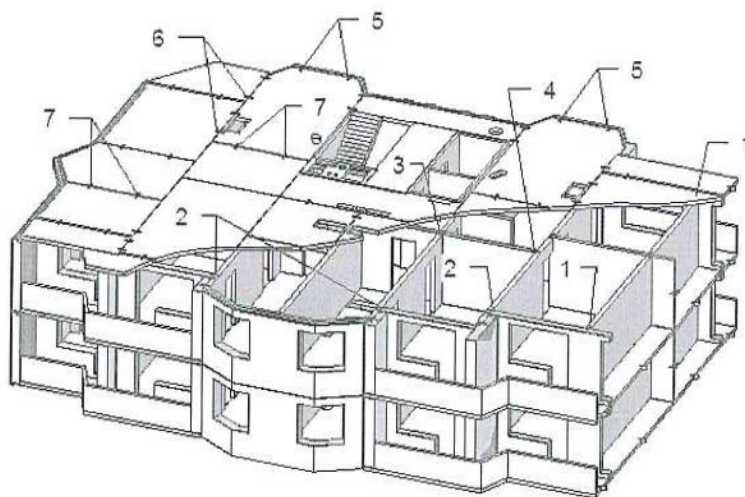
Схема расположения связей в крупнопанельном здании: 1, 2 - связи между наружными и внутренними панелями; 3, 4 - связи между продольными и поперечными внутренними стенами здания; 5 - связи между наружными стенами и плитами перекрытия здания; 6, 7 - связи между плитами перекрытий вдоль и поперек длины здания
